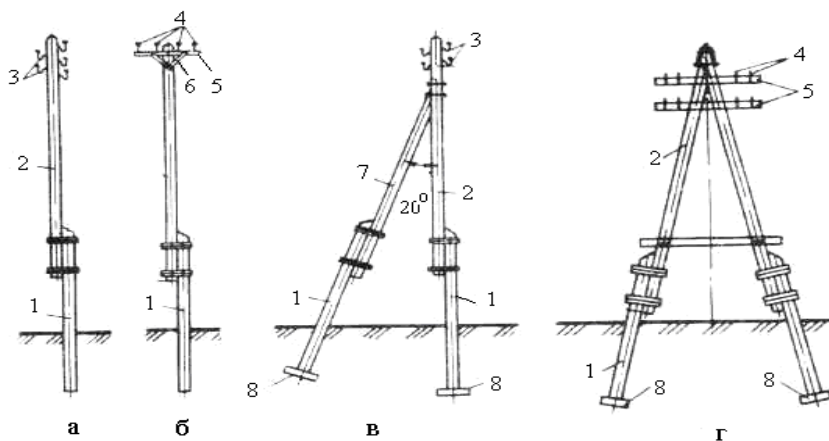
Дерев'яні опори ПЛ на напругу до 1кВ
